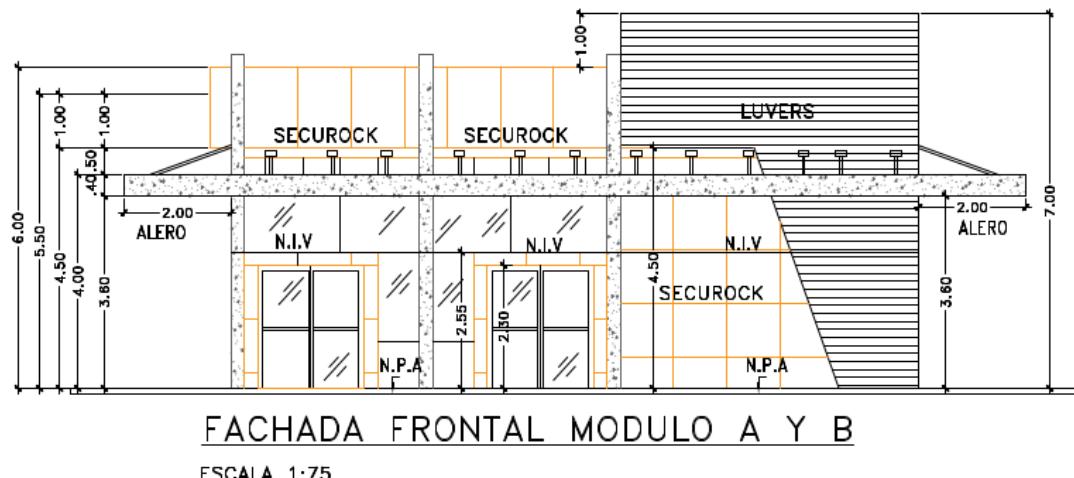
Fachada frontal Módulo A y B. Fuente: Plano del proyecto
